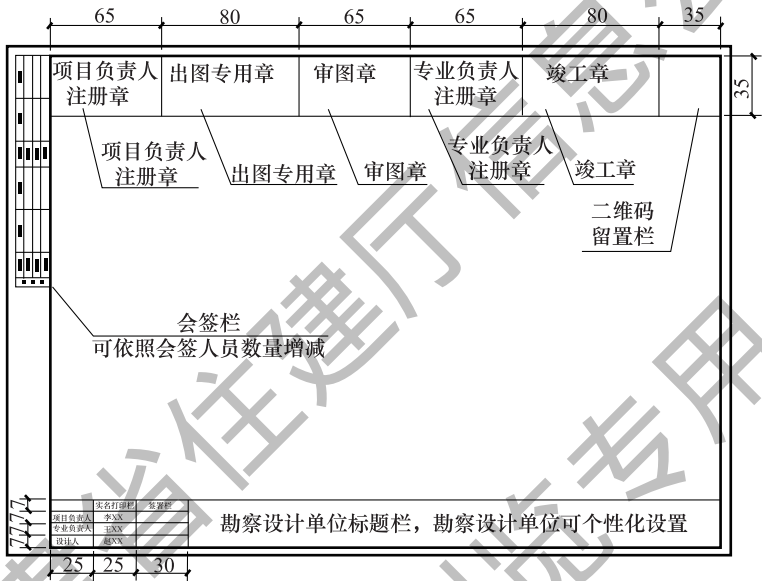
A3 图幅横式幅面标题栏组合布置图(单位:mm)
